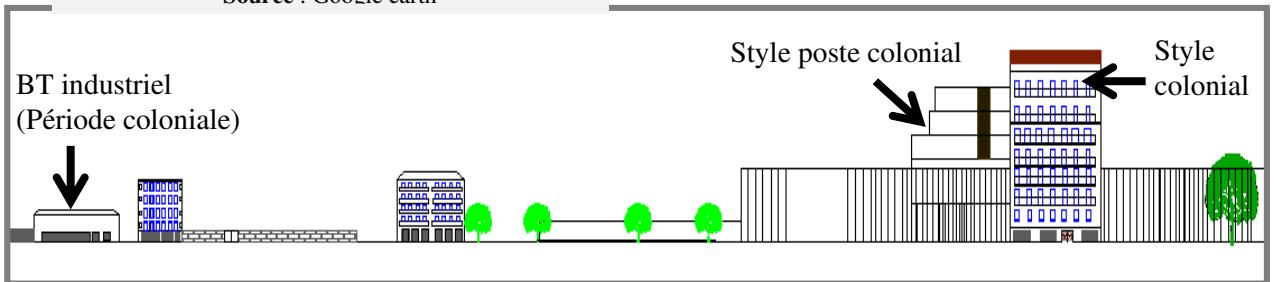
Façade sur le Boulevard Mohamed Belouizdad
